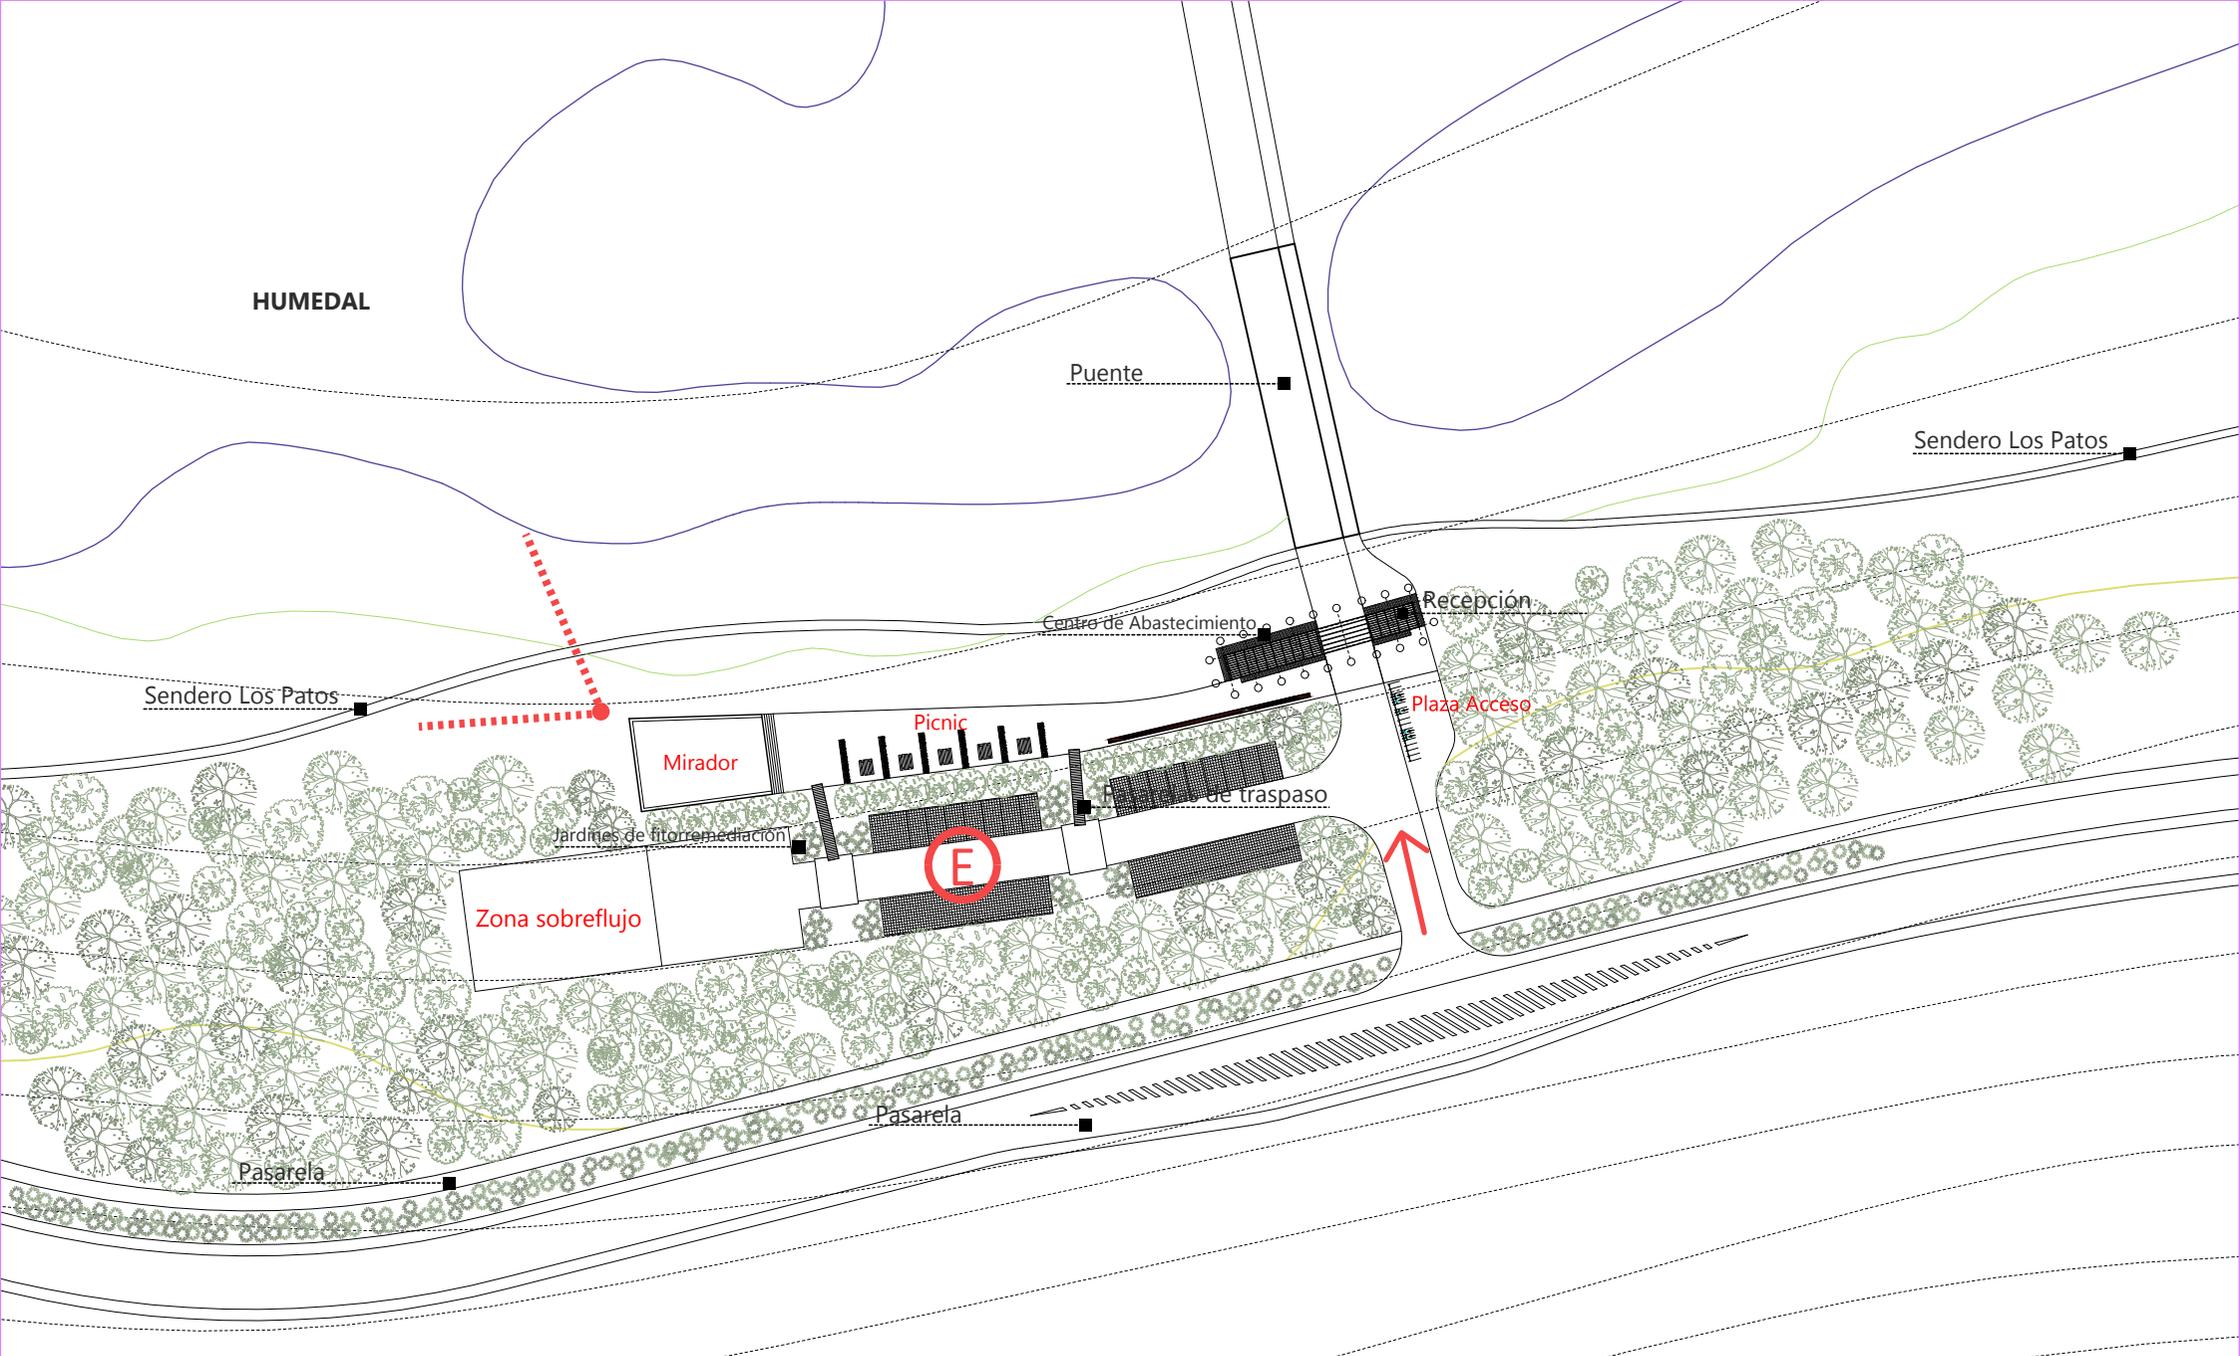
Plano Nodo de Acceso ESC 1:1000
